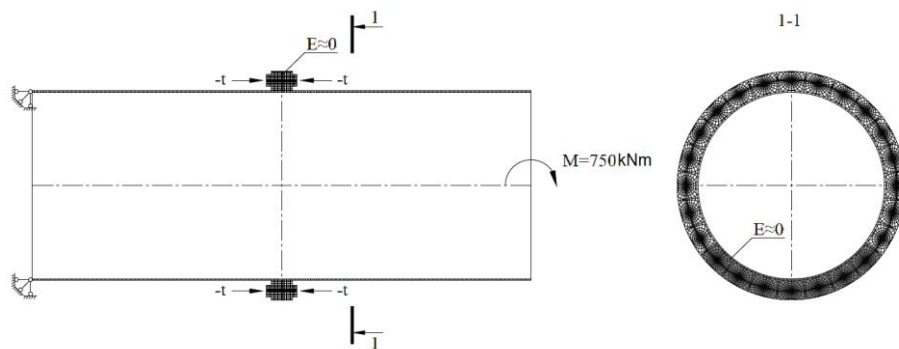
Розрахункова схема фланцевого з'єднання
